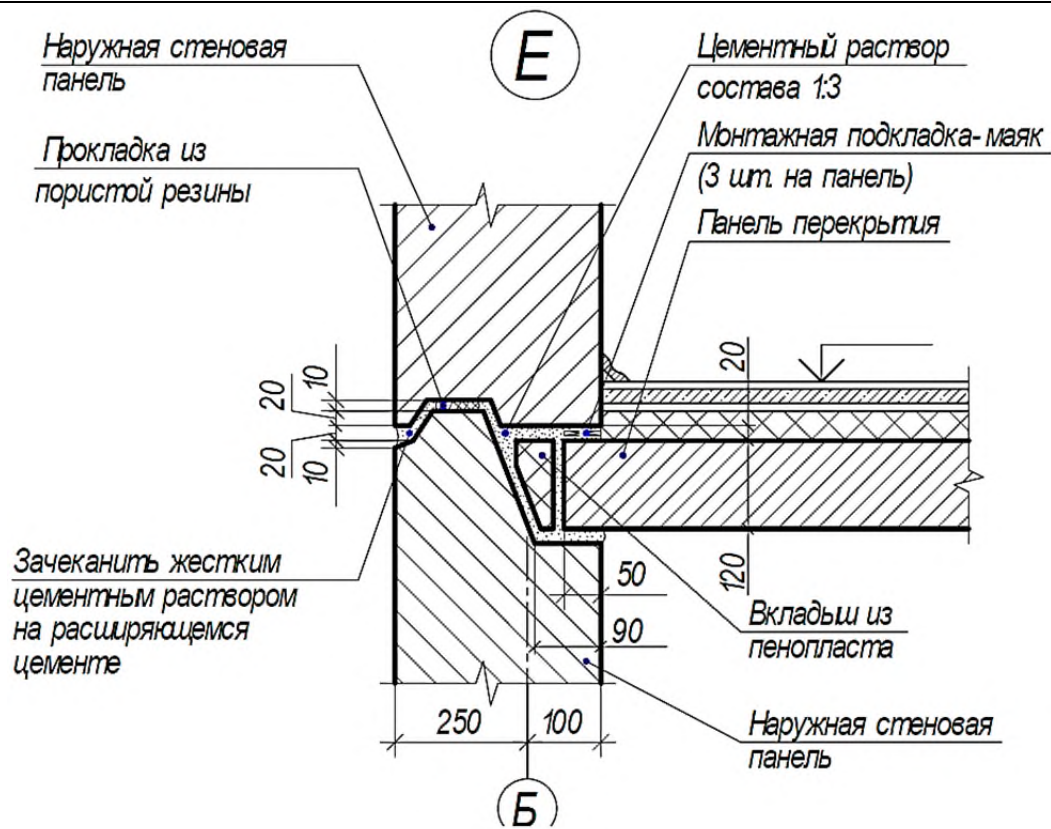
Узел опирания сплошной плиты перекрытия на наружные стены крупнопанельного здания
